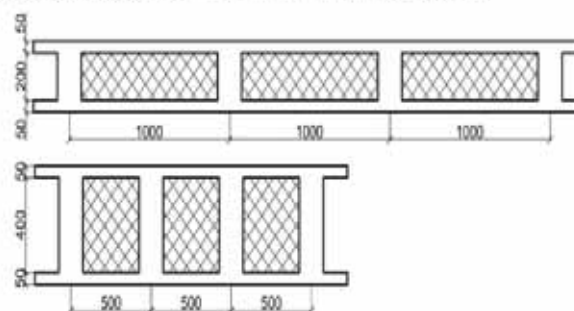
Поперечные сечения рассматриваемых плит перекрытия
